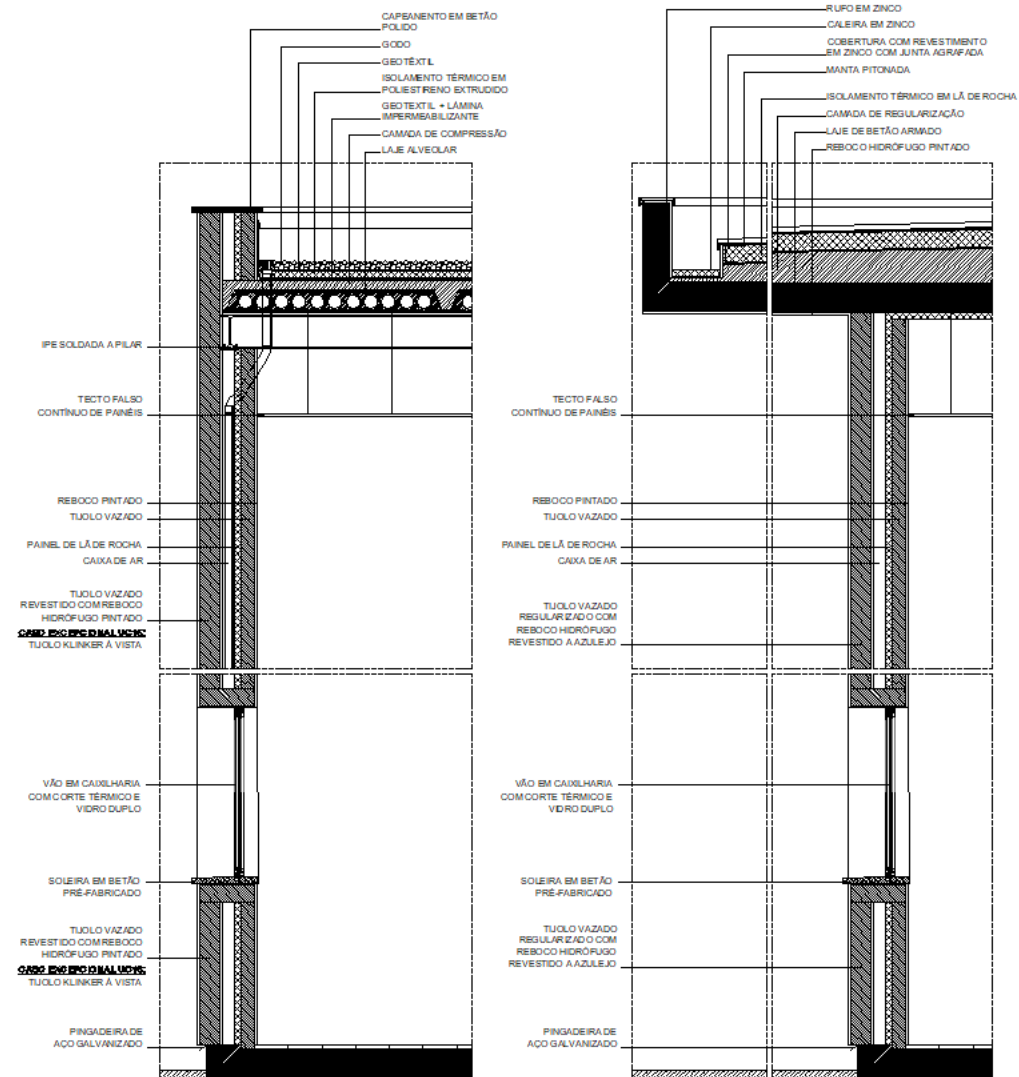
Pormenores de fachada e cobertura – Edifícios de apoio
